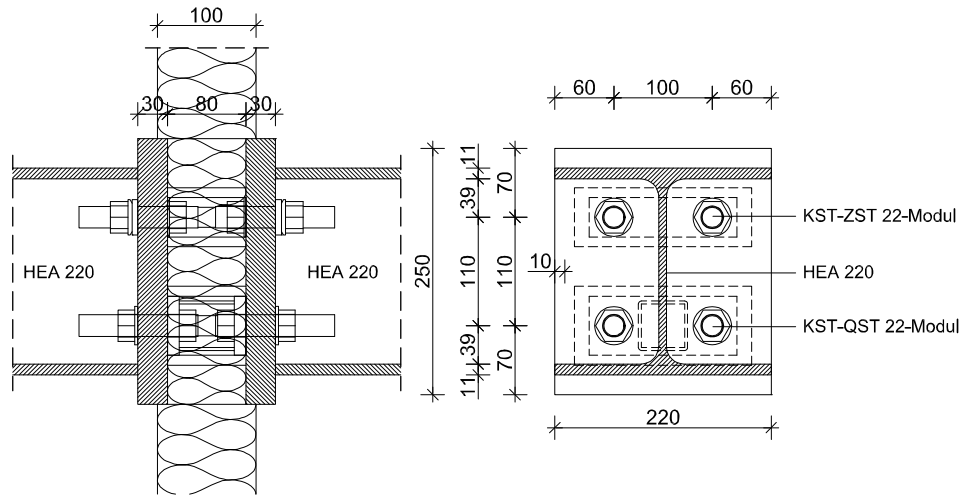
Anschlussgeometrie Stahlträger HEA 220 mit Schöck Isokorb Typ KST 22
